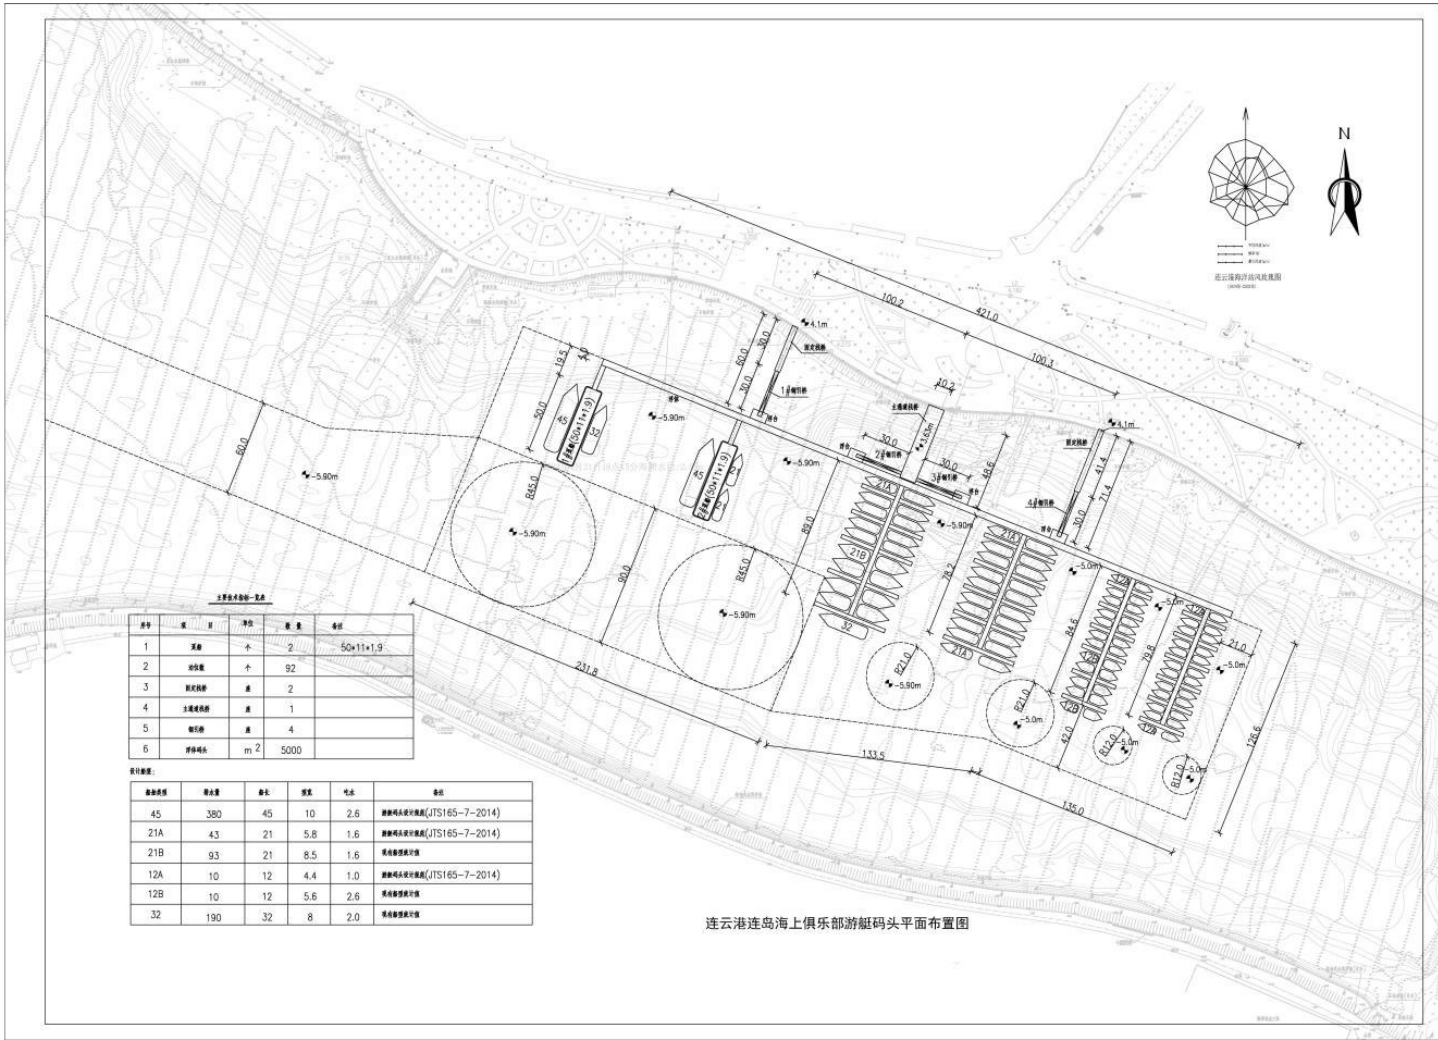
连云港连岛海上俱乐部游艇码头平面布置图
